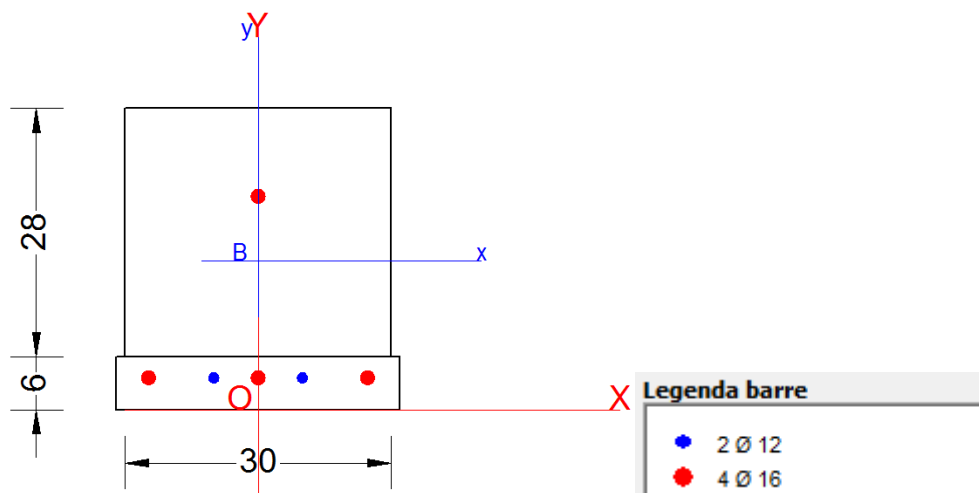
Schema di armatura nella sezione di seconda fase – campata
